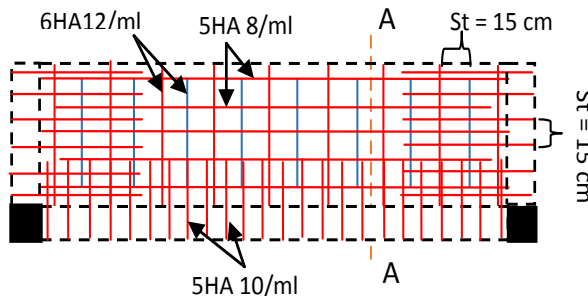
Coupe A-A de la dalle sur 3 appuis RDC
